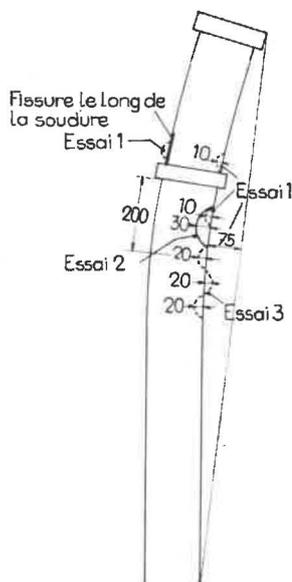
Gondolement des parois du caisson à la fin des 3 essais. Après l'essai 1, la flèche permanente du caisson a atteint 75 mm.
